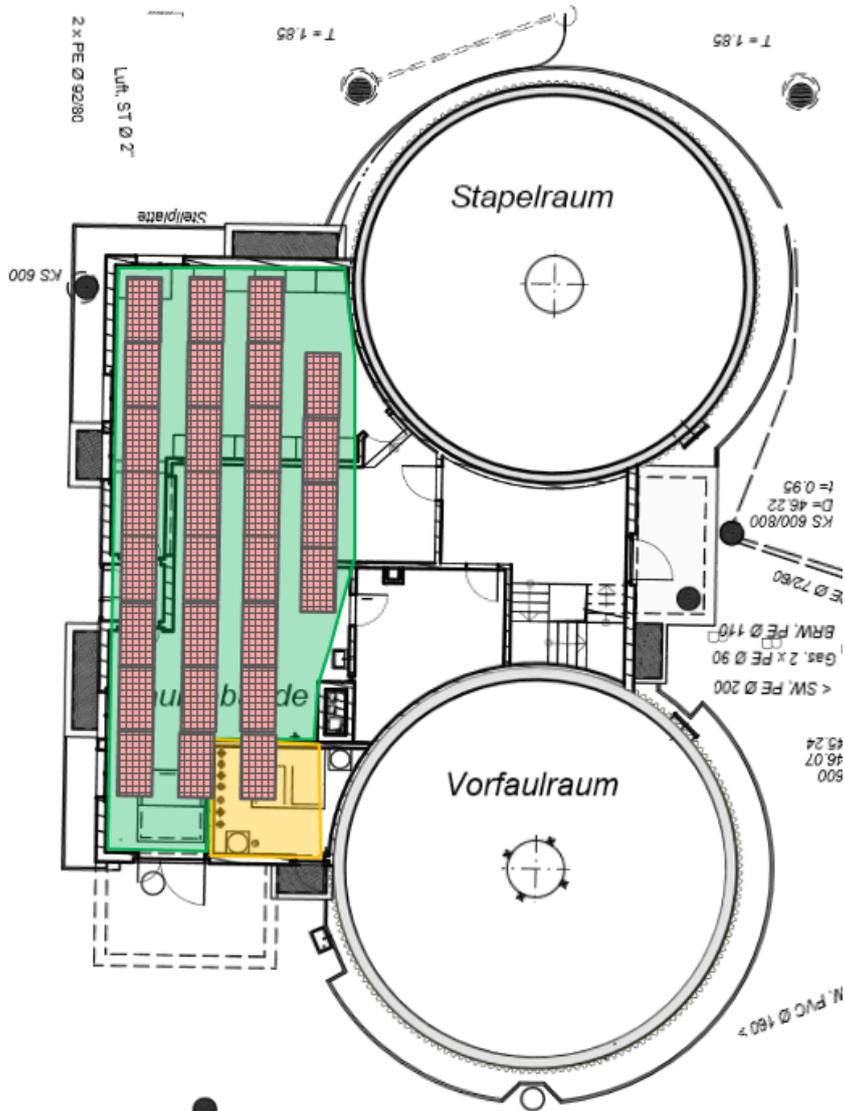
Dachauslegung Faulgebäude, maximal 7.28 kWp installierte PV-Leistung
